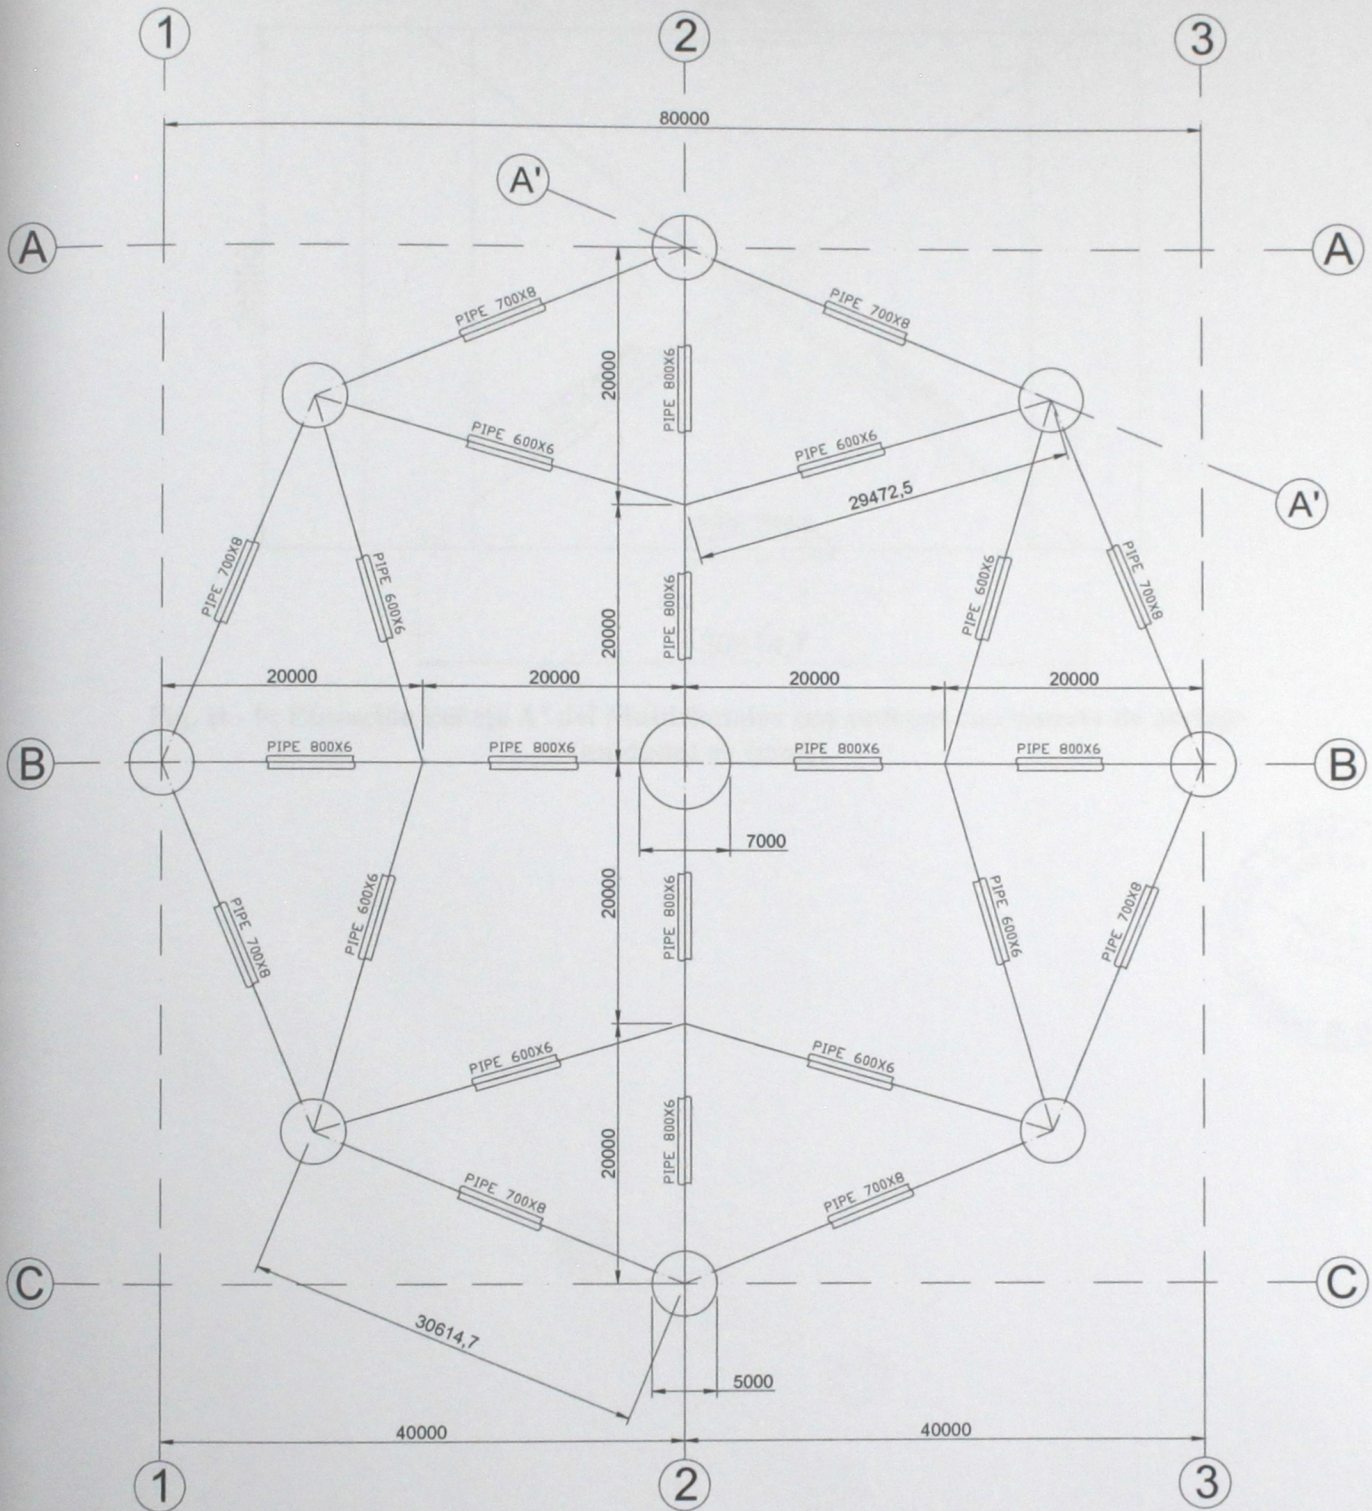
Planta del Multiflotador con cadenas con muerto de anclaje (unidades en [mm])
